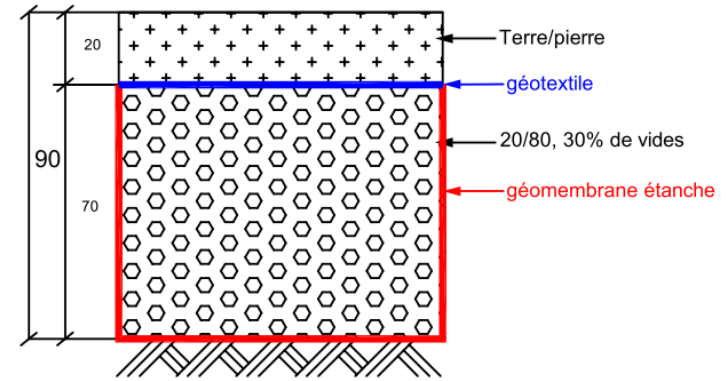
Coupe de la chaussée stockante en terre/pierre (Jardins du MeM) – Source : ORA
